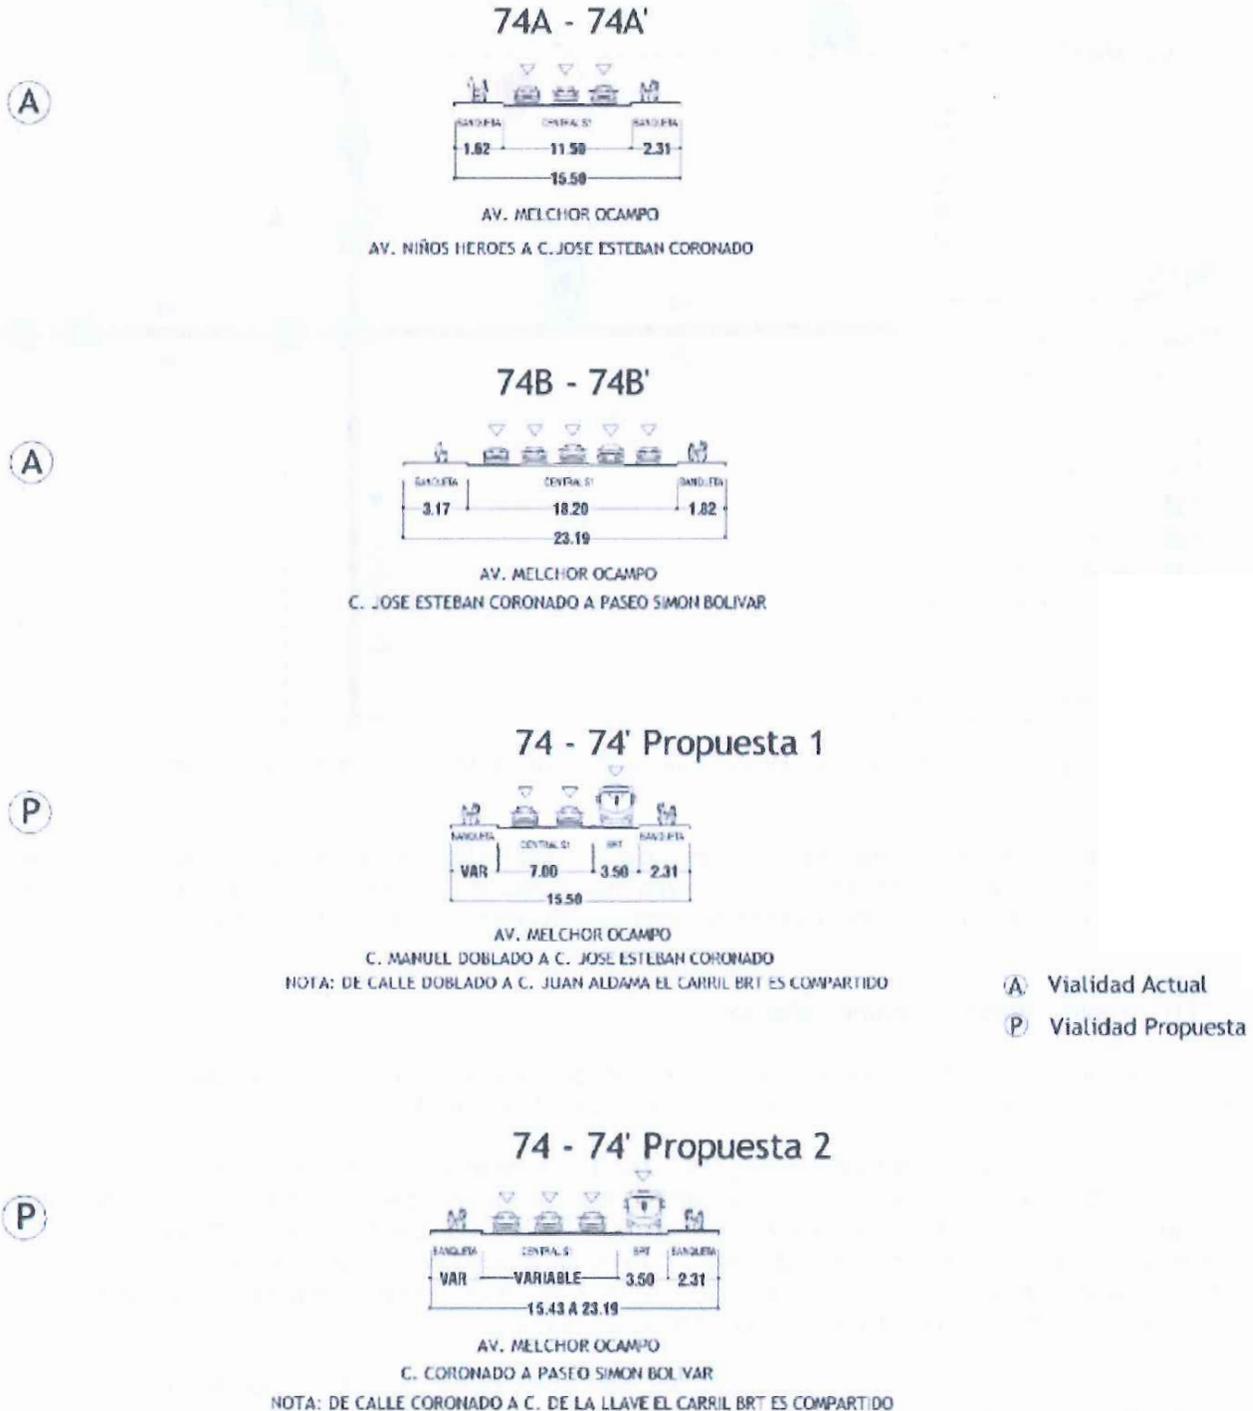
Secciones viales actuales y propuestas para Avenida Melchor Ocampo Manzo. Fuente PDU 2040.
